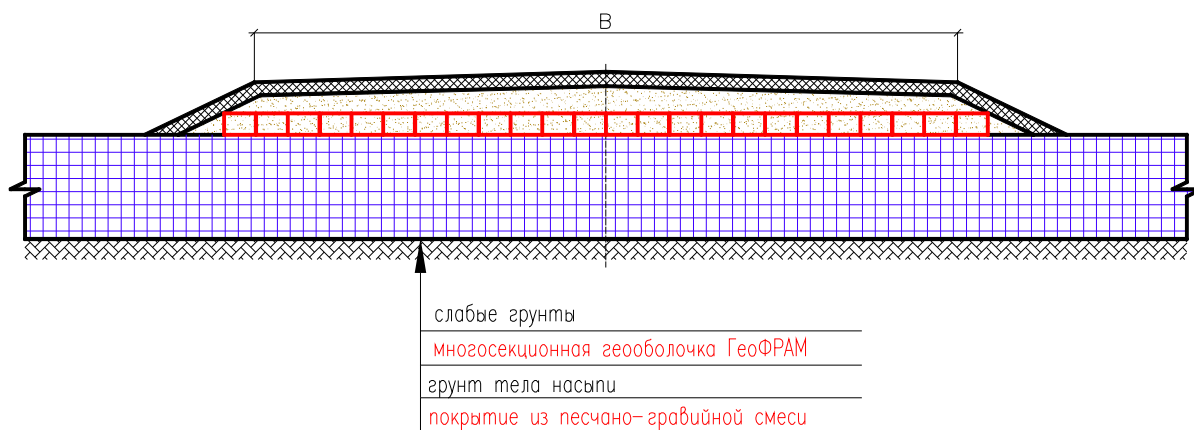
Поперечный профиль конструкции вертолётной площадки, сооруженной с применением геоблочки «ГеоФРАМ», заполненной грунтом и ПГС
